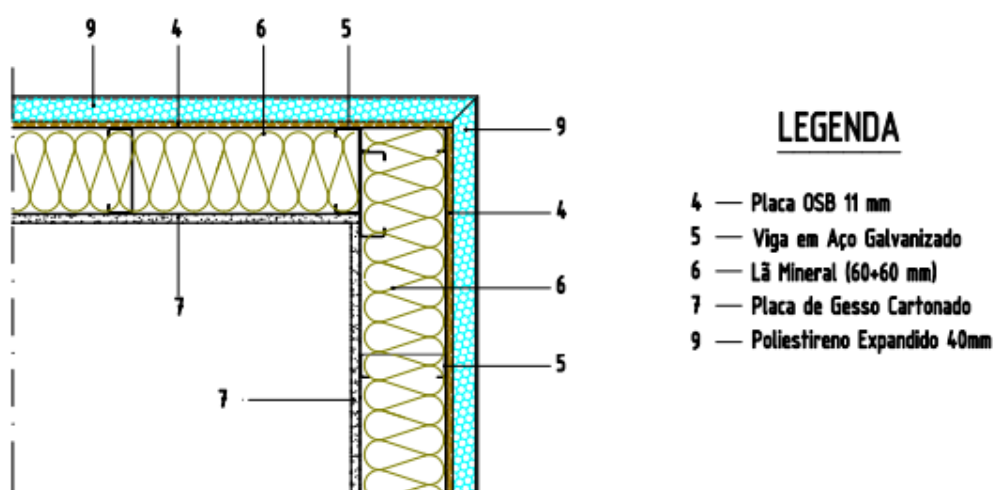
Pormenor construtivo da ligação entre duas paredes (Futureng, 2018d).
